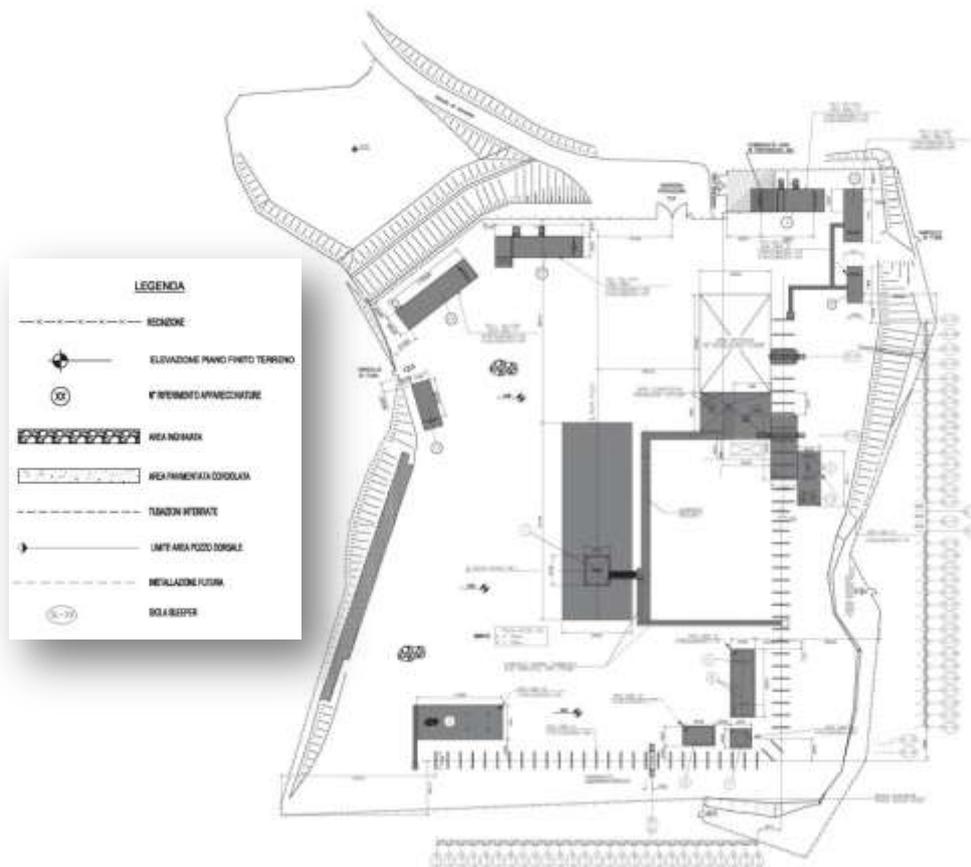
Pozzo PE1 Planimetria generale e Opere civili
